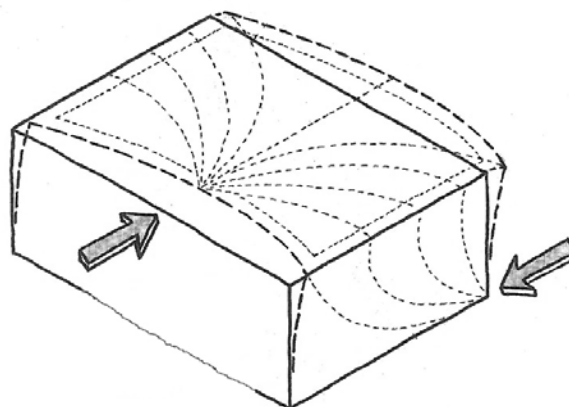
Deformación del conjunto ante esfuerzos [Bruce King con Kevin Donahue, op. cit]
